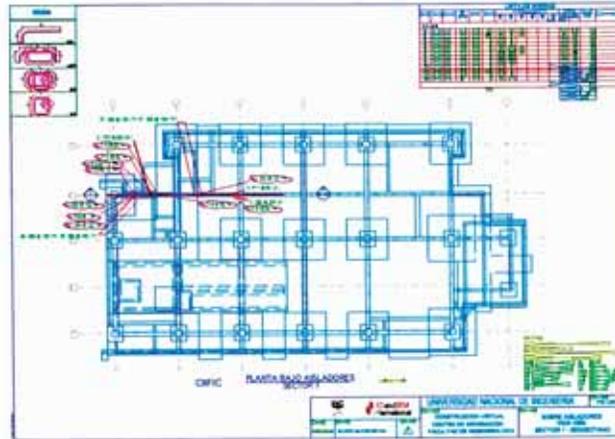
Creación de planos de Tekla Structures y vistas por defecto
